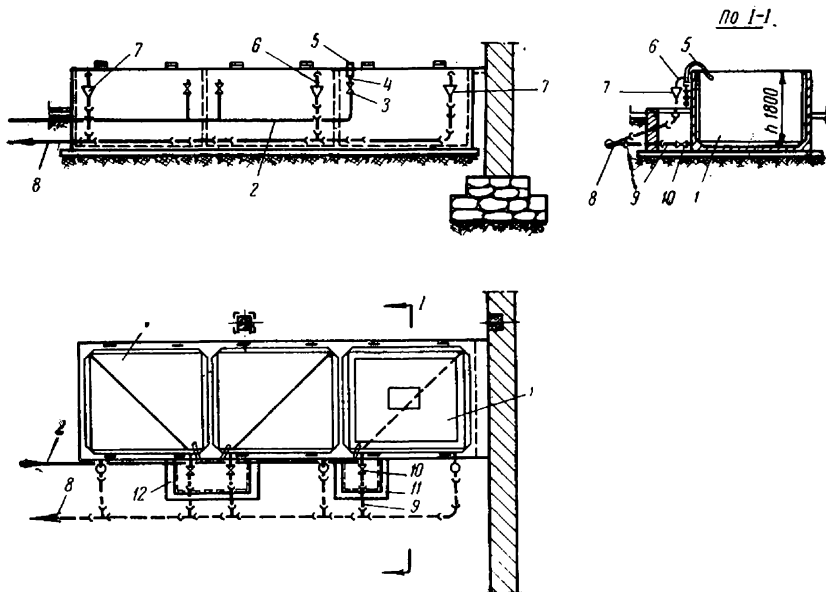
Компоновка линии с тремя посолочными чанами конструкции Гипро-
